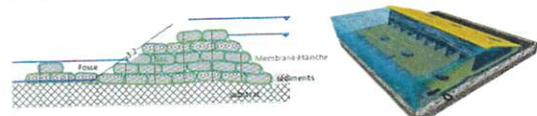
Coupe transversale du seuil en mur poids (à gauche) et illustration d'une barrière amovible (à droite, WaterGate/D - MegaSecure)
